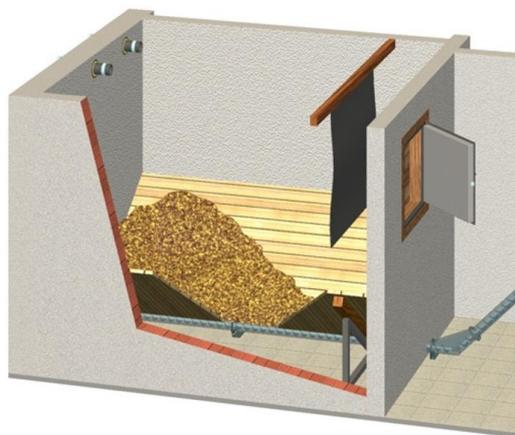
Sistema di scarico dei pellet con pavimento inclinato[66].
